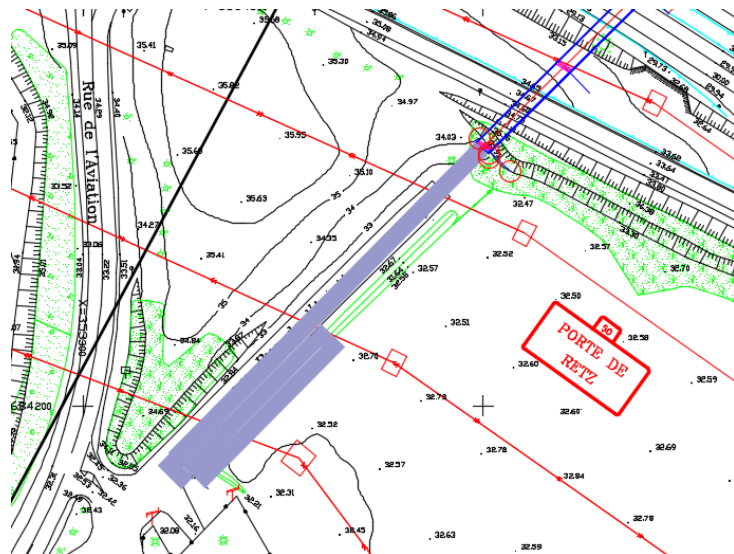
Variante d'implantation de la rampe sud d'accès à la passerelle
